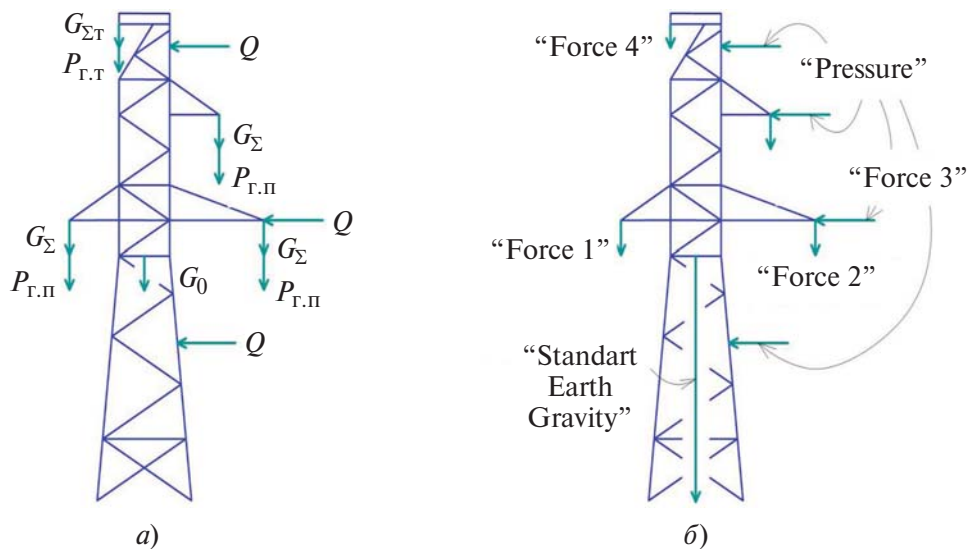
Схемы распределения расчетных нагрузок стальной решетчатой опоры (а) и точки их приложения на модели (б)
